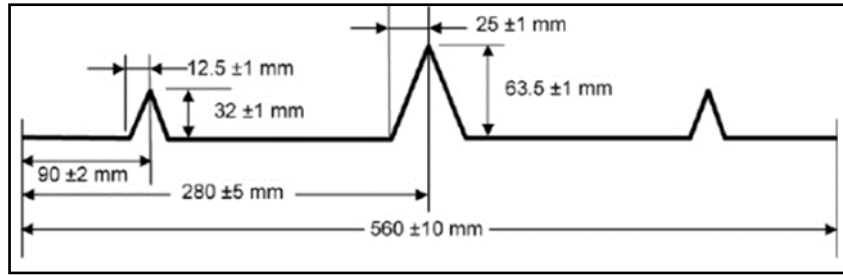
Molde en vista elevación. Tomado de ASTM C 1579.
